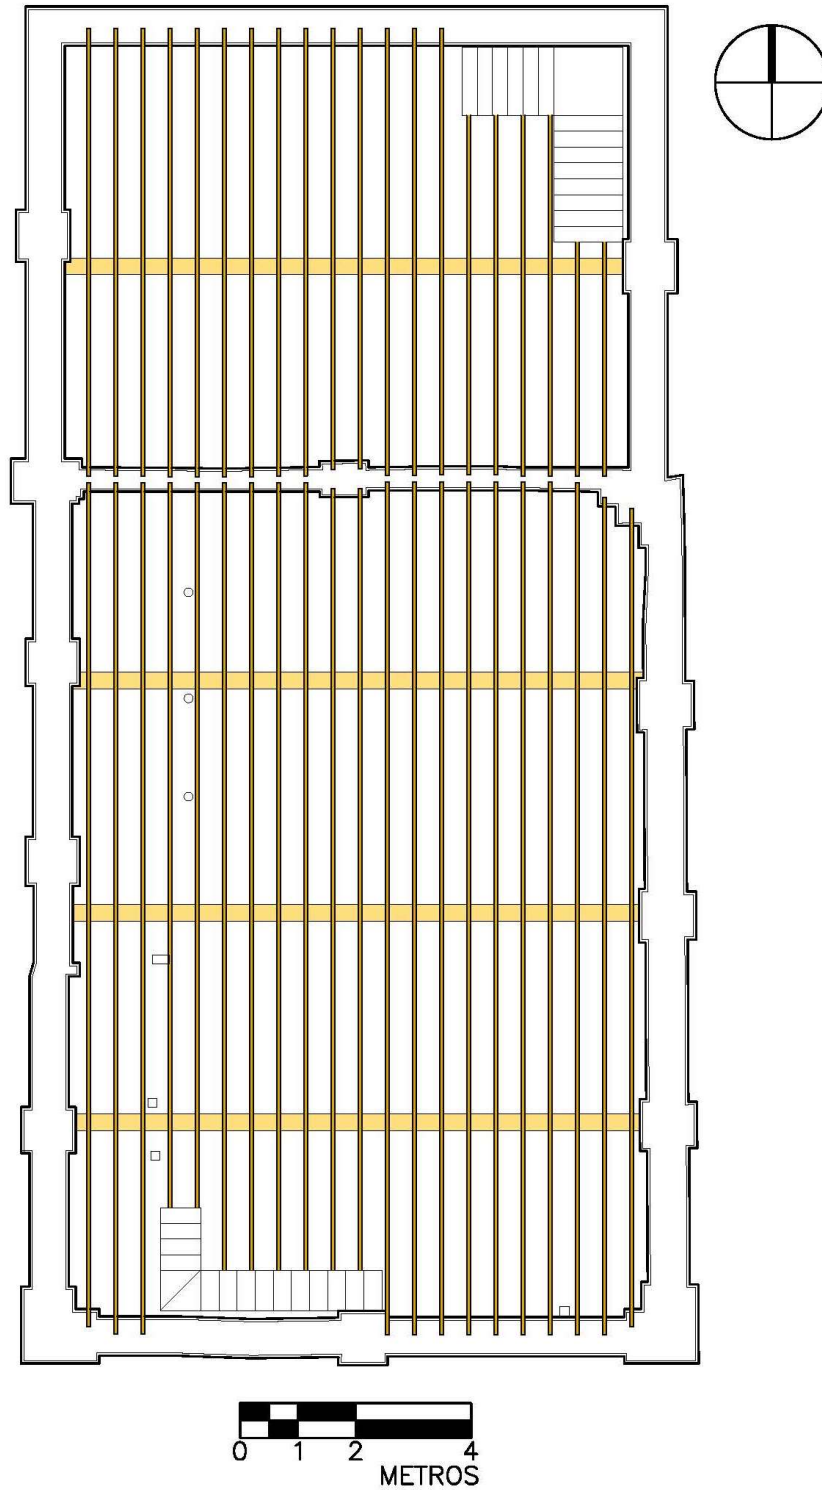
Levantamiento del estado actual. Viguería en planta primer nivel, a partir de este nivel las vigas están acomodadas una por una equidistantes entre sí, la distribución de las vigas principales sigue el ritmo de las columnas de los muros de tabique. Elaboración por M.A.R.C.
